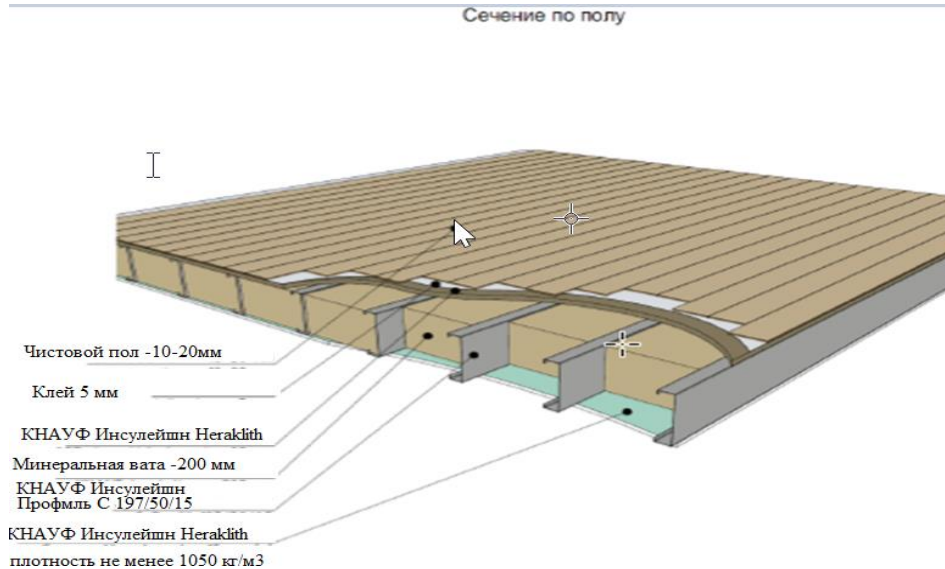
Межэтажное перекрытие без контробрешетки
